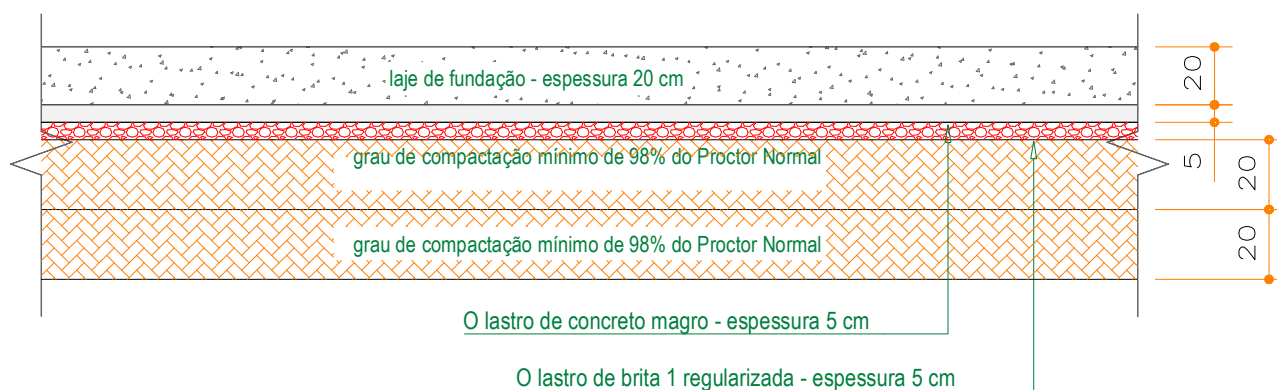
Corte genérico da seção transversal do conjunto *Laje de Fundação* / Lastro de Concreto Magro / Lastro de Brita / Recompactação.
